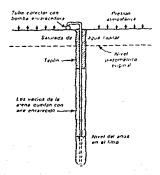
INSTALACION DE POZOS PUNTA PARA ABSORCION
